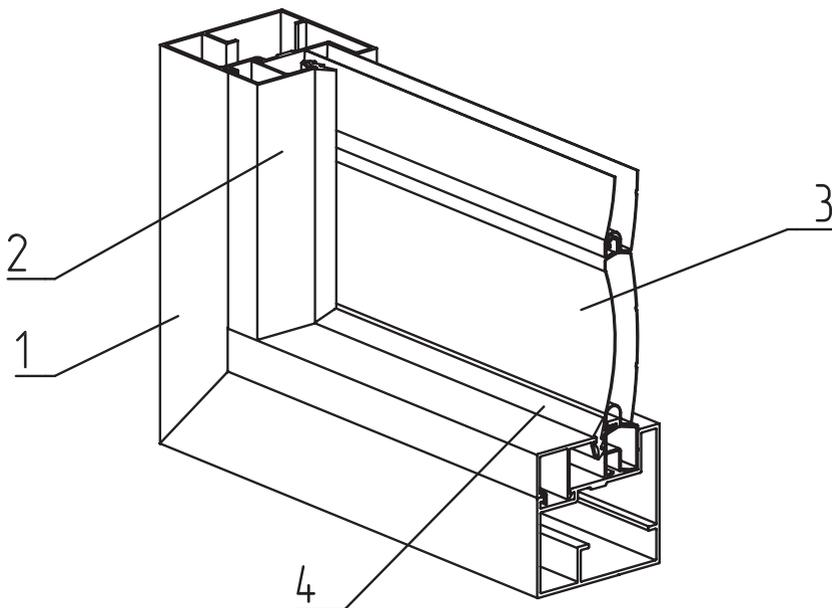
Установка штапика FLGU.400.0304 с уплотнителем FRK39
